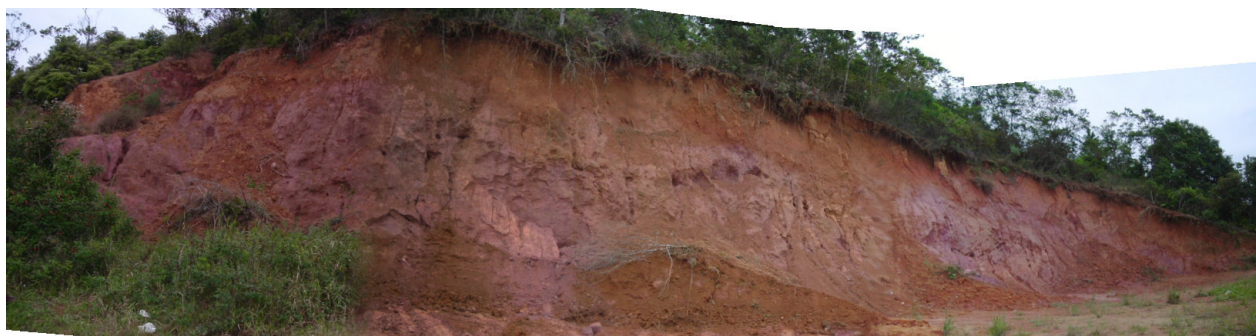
Jazida J5 (Ca1) outro morro no Jardim Acarai – Cambissolo.
